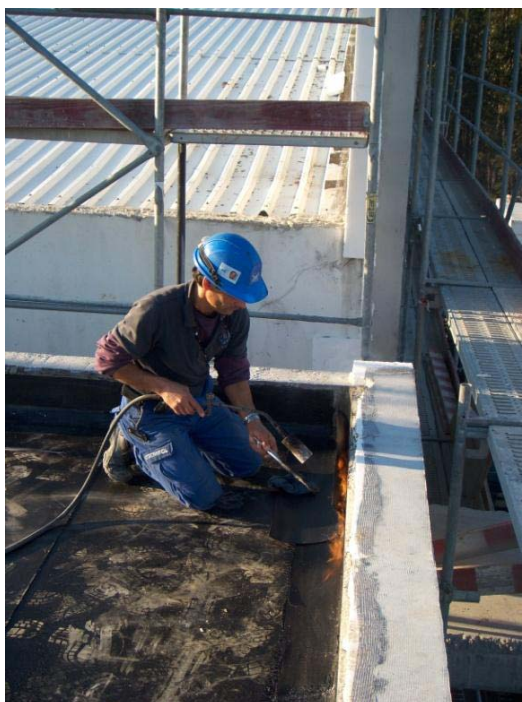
Aplicação de Telas Impermeabilizantes (2ª Tela)
